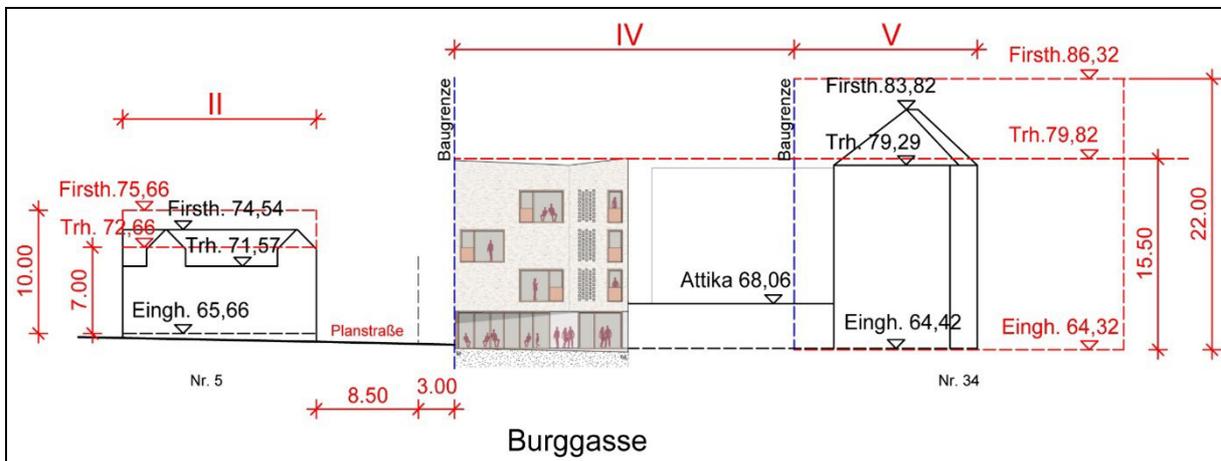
Systemzeichnung – Fassadenabwicklung Burggasse – Entwurfsplanung (mit Darstellung Mehrgenerationenkunst- und Begegnungshaus – Studie „schularchitekten“, Köln)
